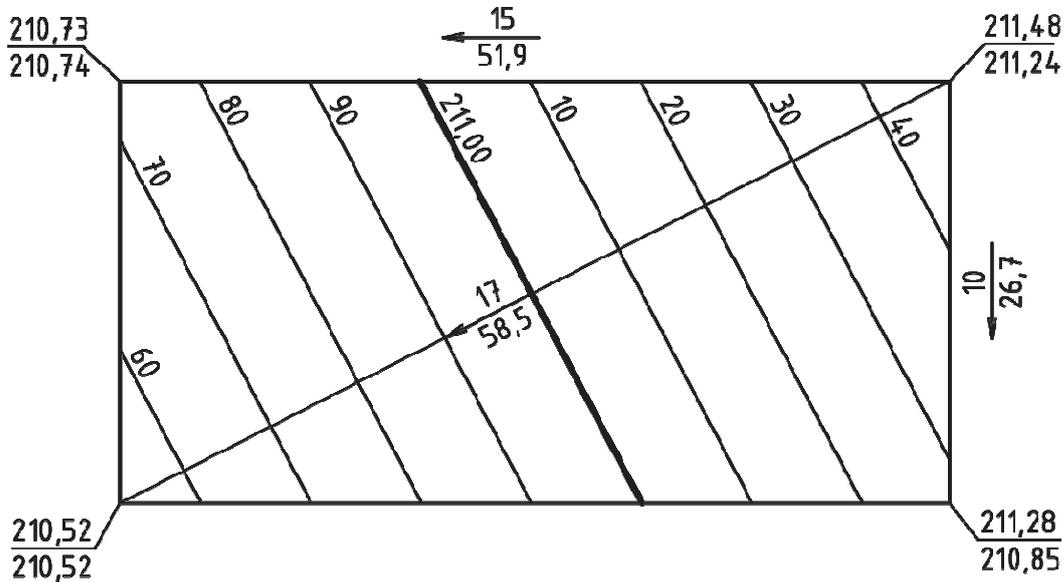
Пример схемы вертикальной планировки односкатной площадки
